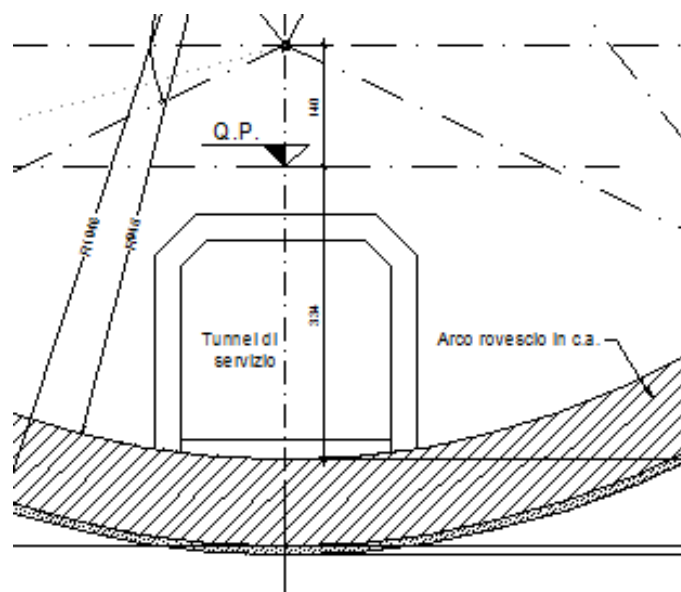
SEZIONE TRASVERSALE TUNNEL DI SERVIZIO
